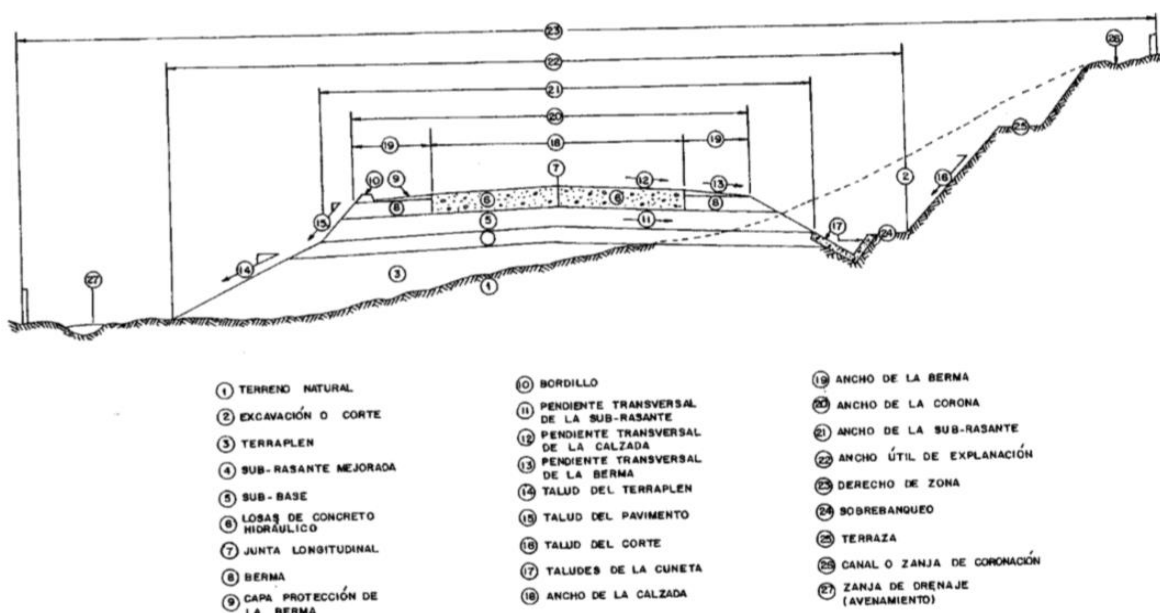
Sección típica de un pavimento rígido Fuente: Montejo Fonseca Alfonso, "Ingeniería de Pavimentos para Carreteras", pág.6.
